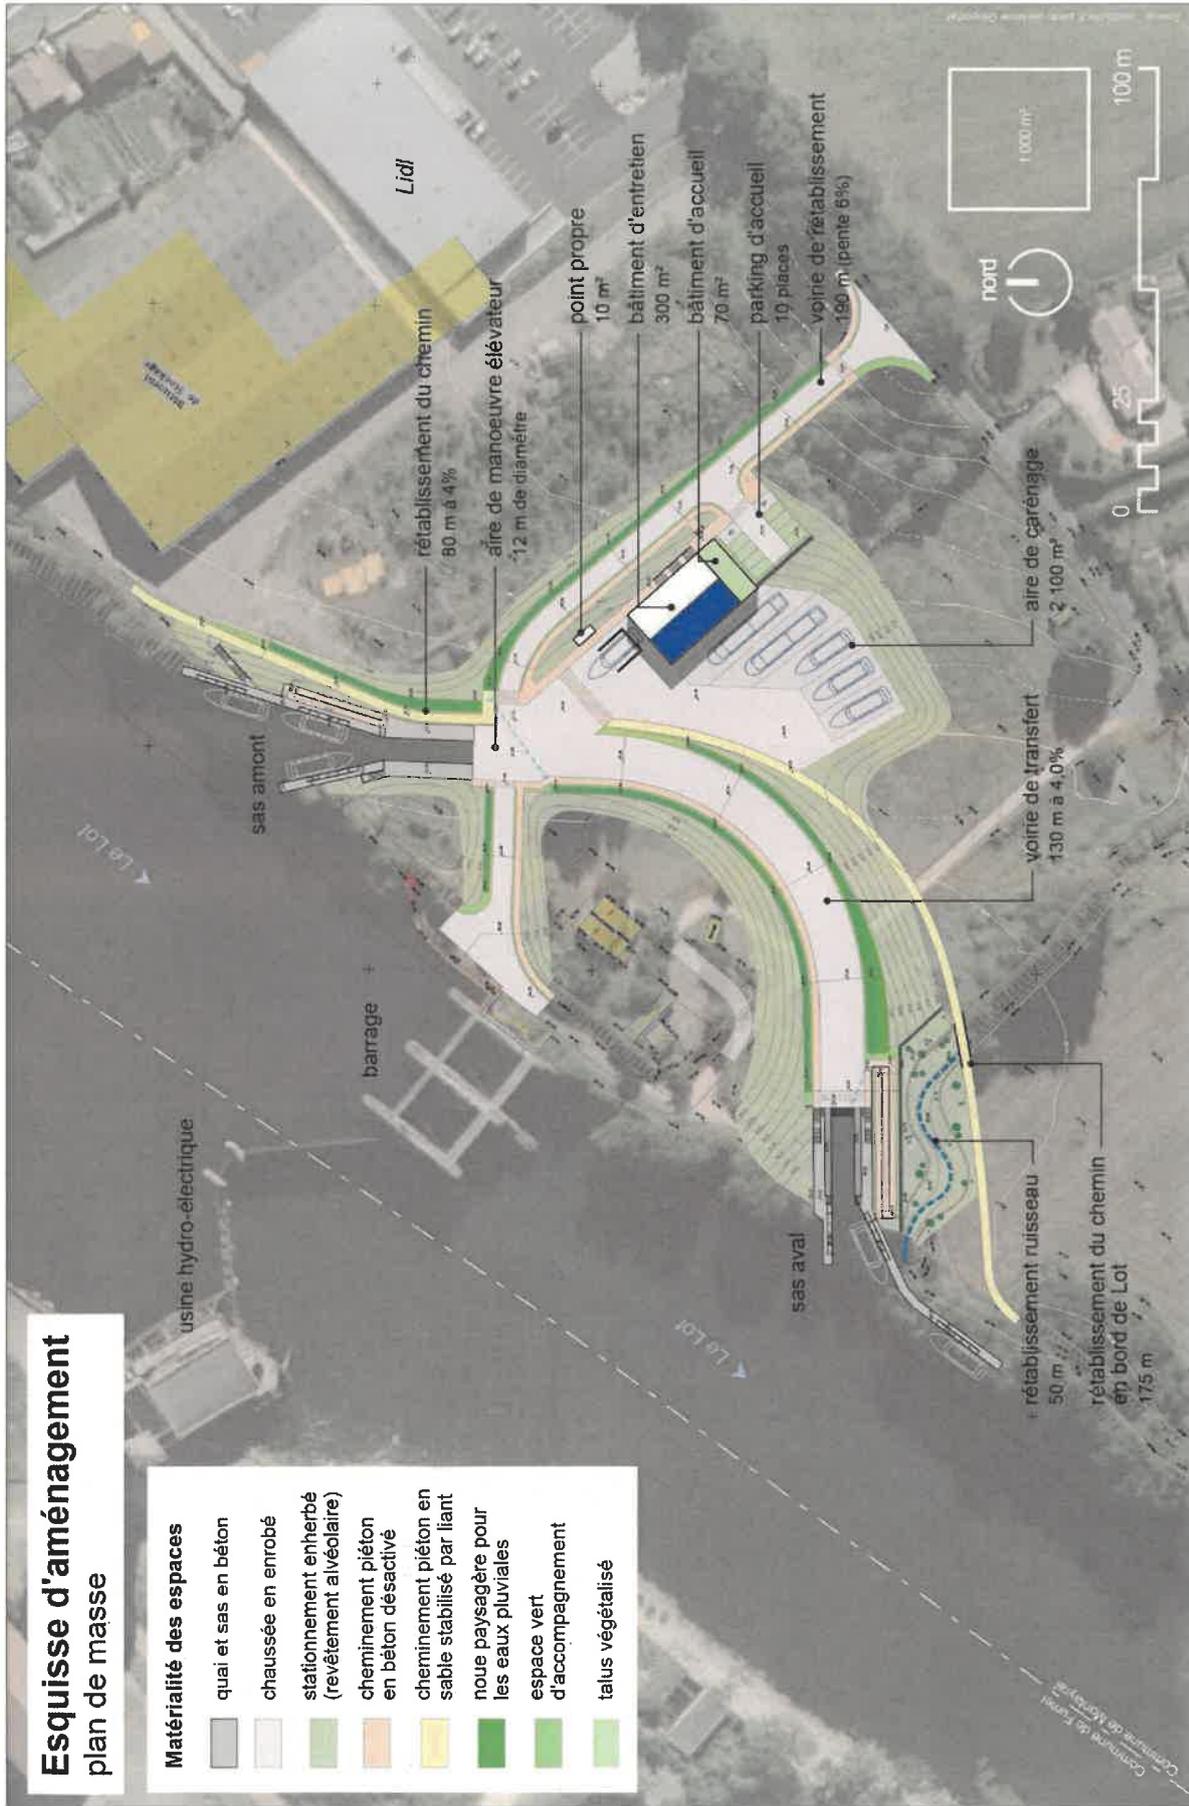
Plan de masse de l'esquisse d'aménagement du transbordement du barrage de Fumel
